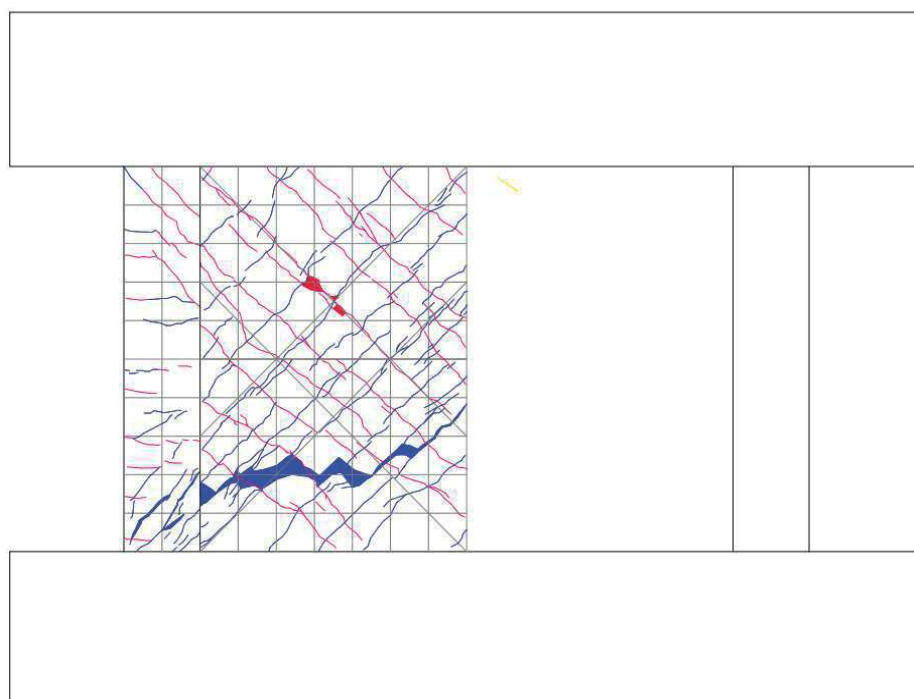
試験体 S-06-DIV 最終破壊時ひび割れ図
